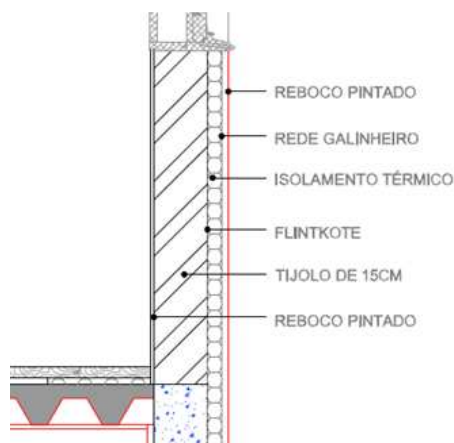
Pormenor construtivo (parede em tijolo com revestimento sobre isolamento térmico exterior)
